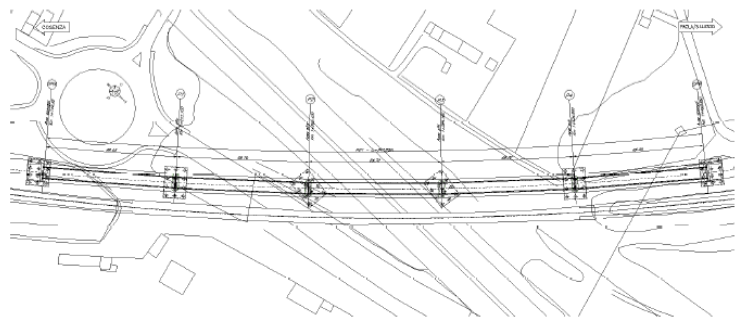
Planimetria del viadotto ferroviario VI01b
